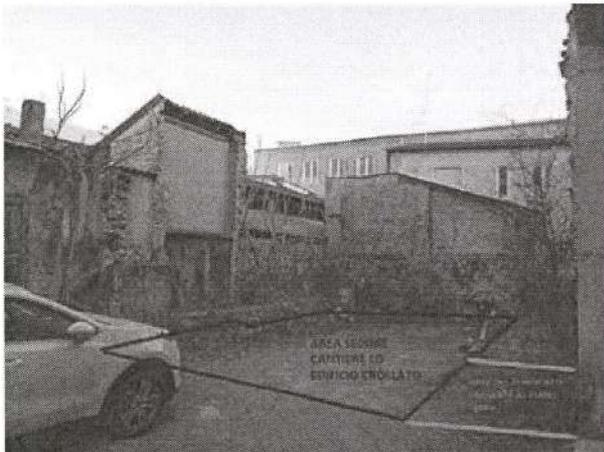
FOTO AREA DI CANTIERE ATTUALE CON INDIVIDUAZIONE AREA SEDIME VECCHIO EDIFICIO
